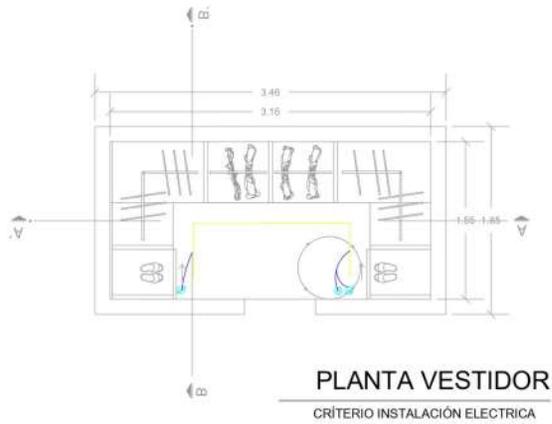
Detalles constructivos de closet. Elaboración propia , 2022
